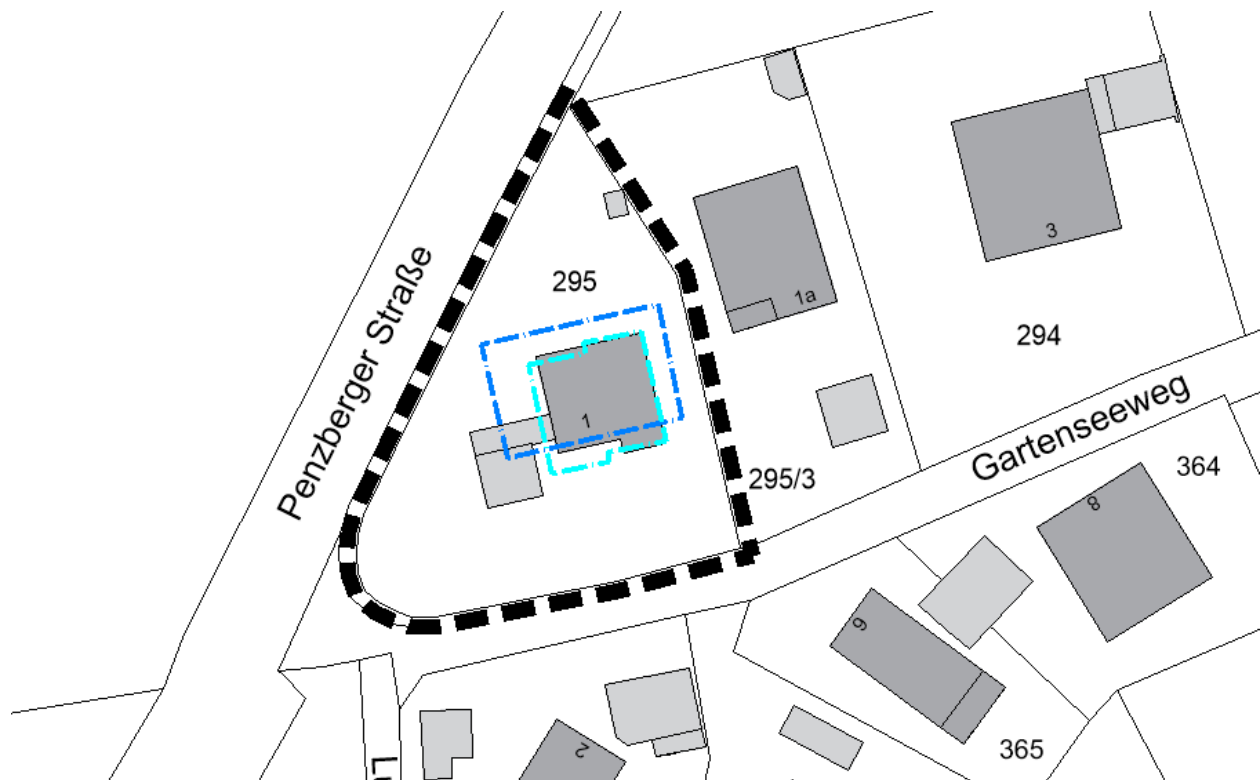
Überlagerung des Baufensters der 17. Änderung (cyan) mit der geplanten Baugrenze (blau)
